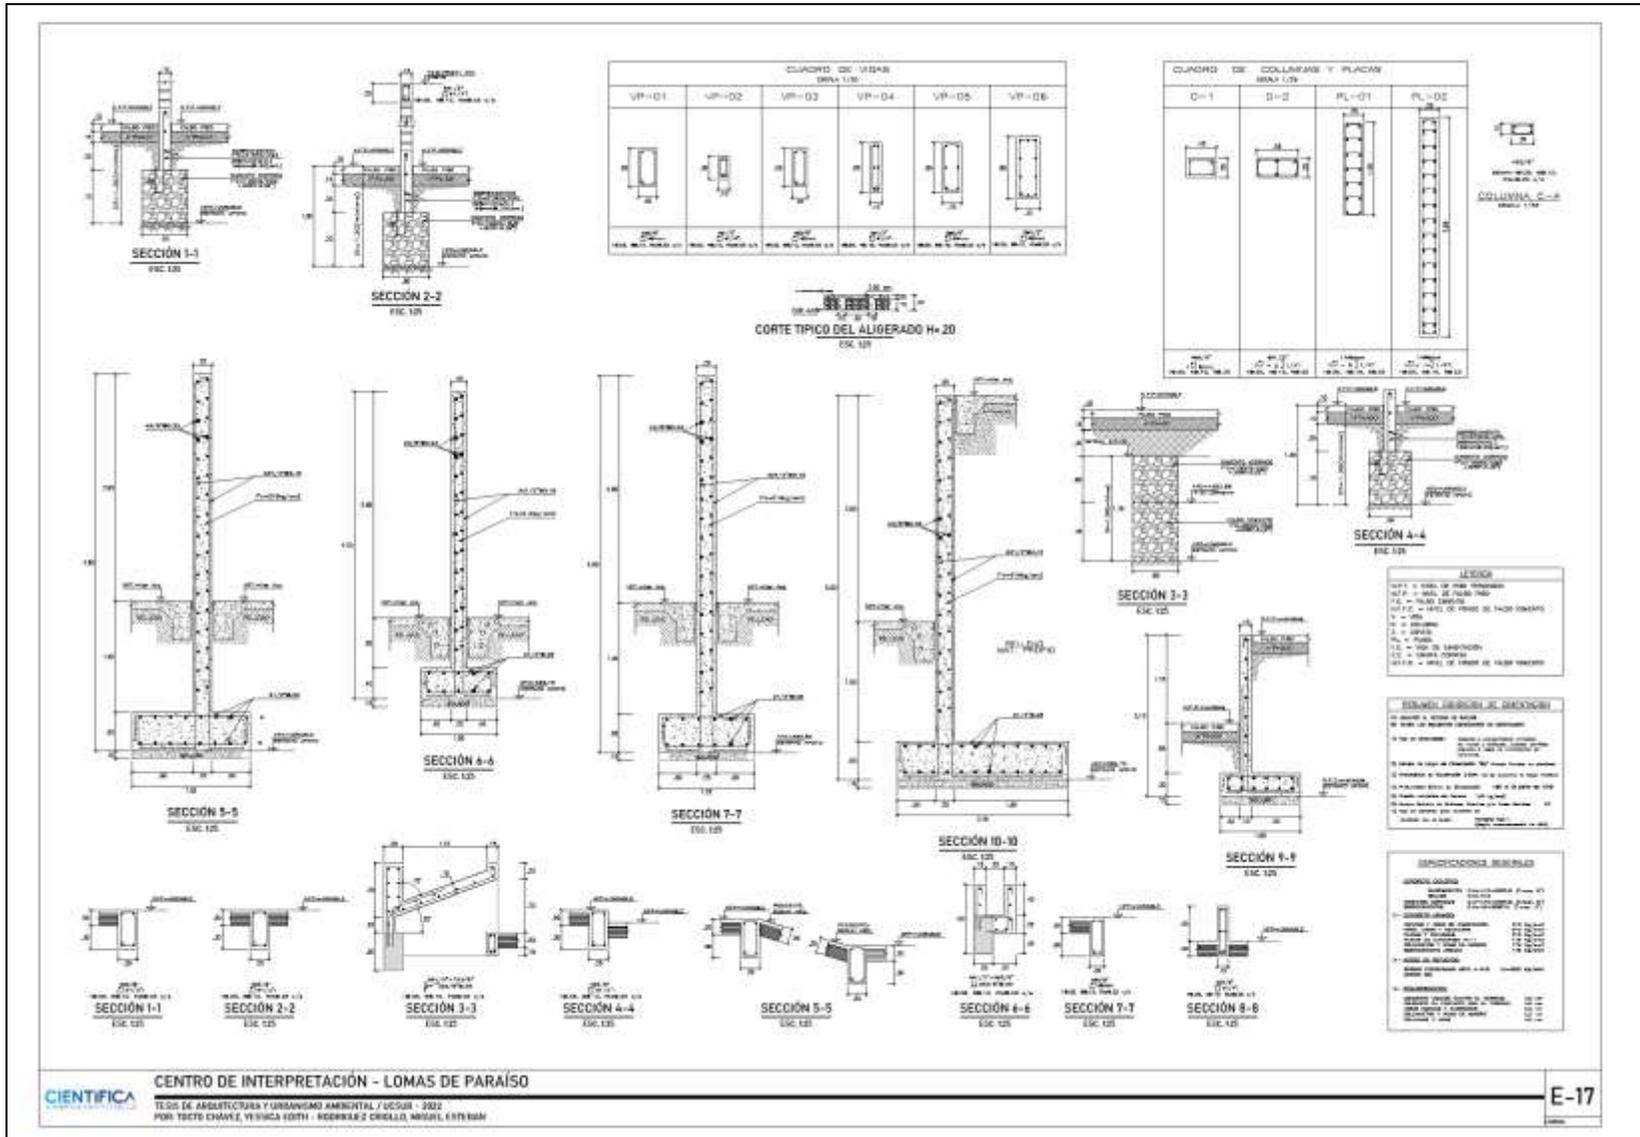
Centro de Interpretación – Cuadro de elementos estructurales y detalles.
